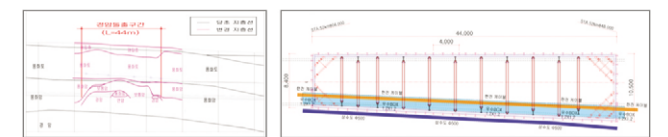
경암돌출부 종단면도 및 가시실 평면도
